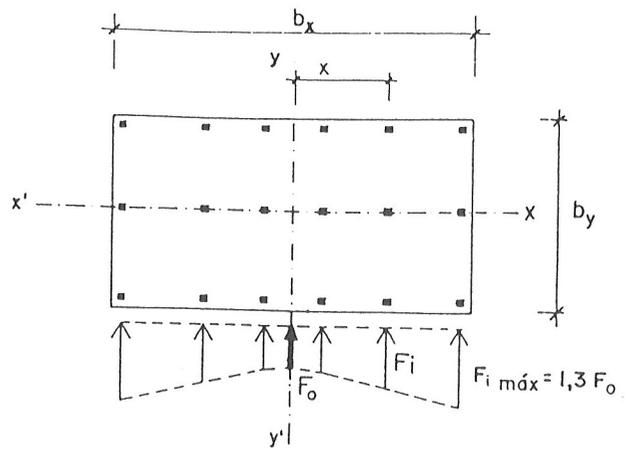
Excentricidad en planta de la acción sísmica.
